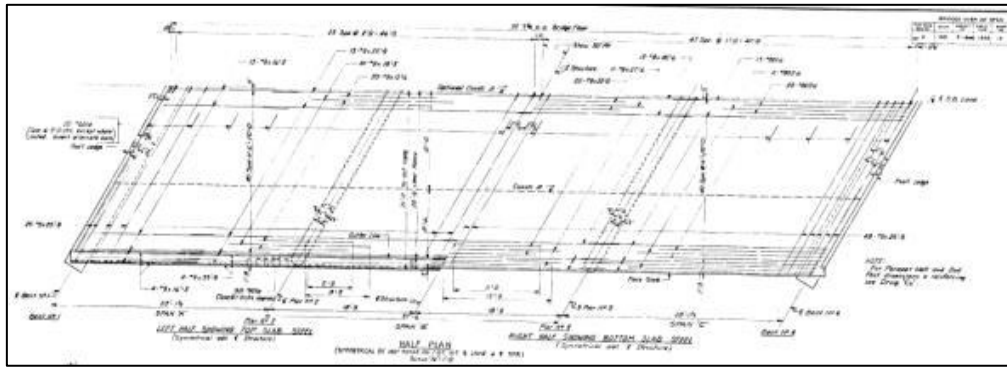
Planta refuerzo inferior y superior de superestructura puente No 2
